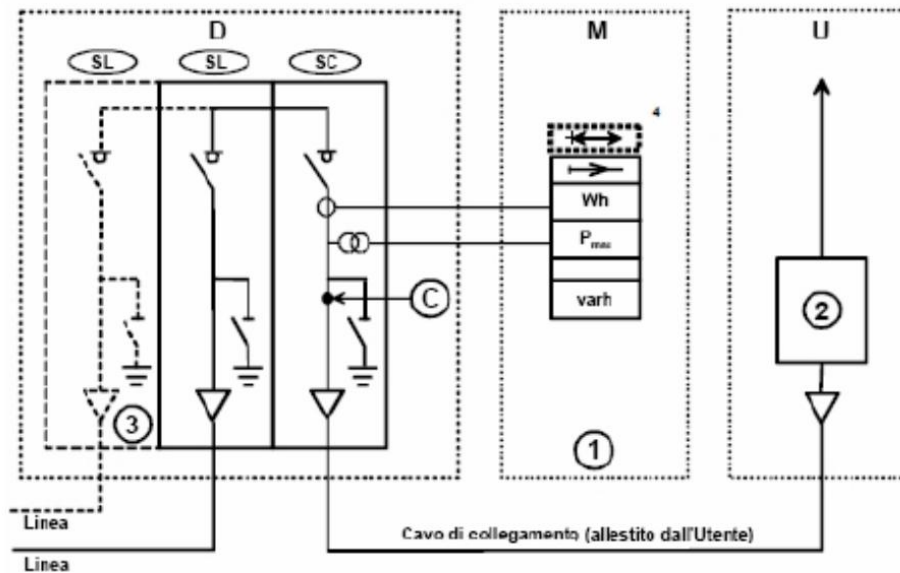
Schema di collegamento fra la cabina consegna e l'impianto Utente
